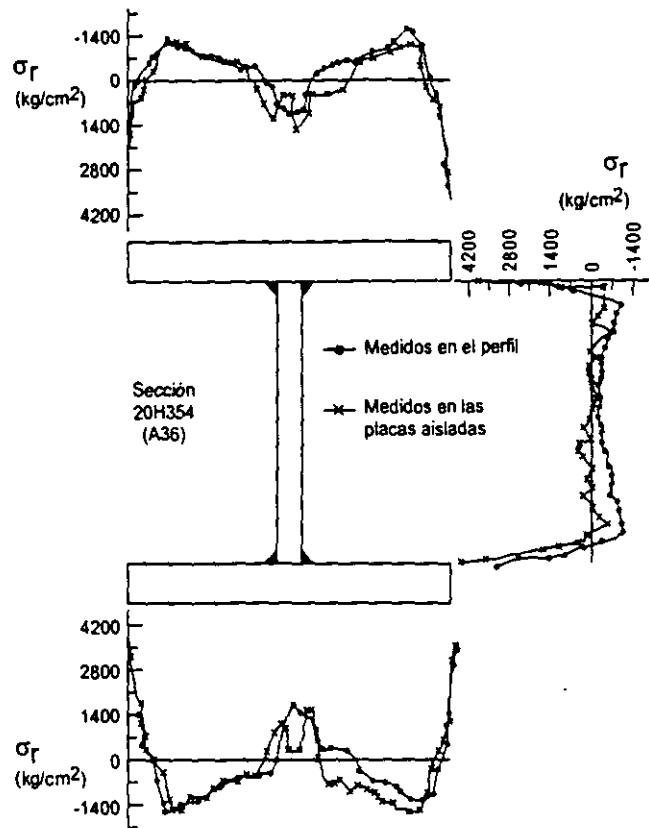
Esfuerzos residuales en una sección H soldada, hecha con placas cortadas con soplete.
